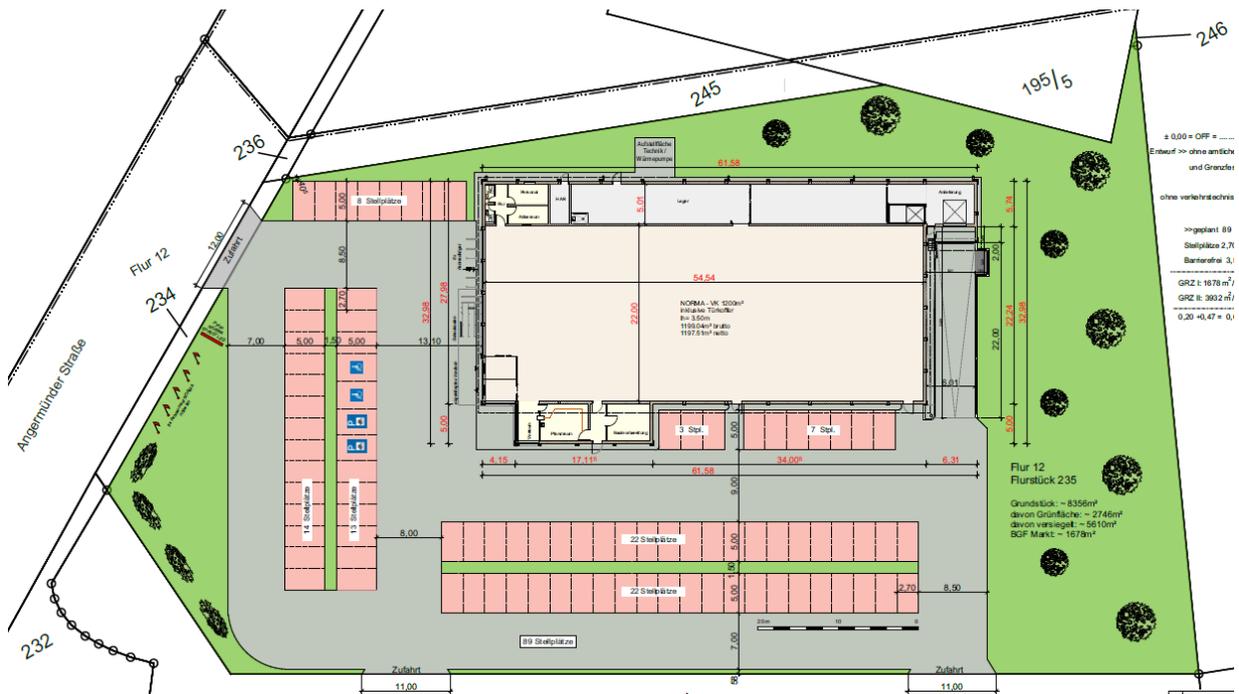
Entwurfsplanung - Ausschnitt aus dem Lageplan, Die Baudenker; 05.05.2025
